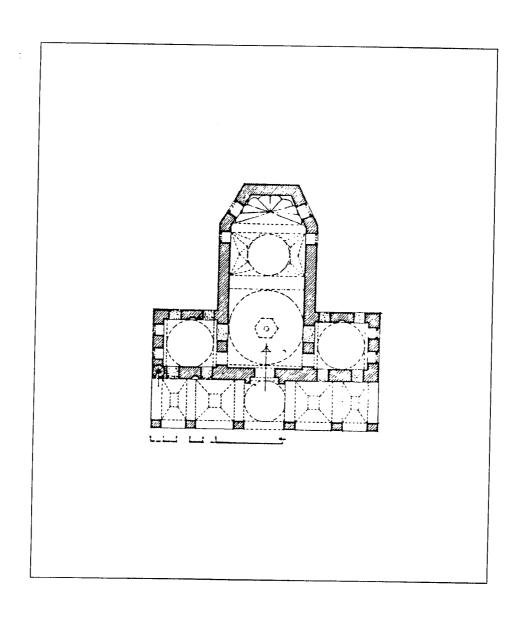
مسقط أفقي للمسجد الكبير في البستان (عن: اصلان ابا)
